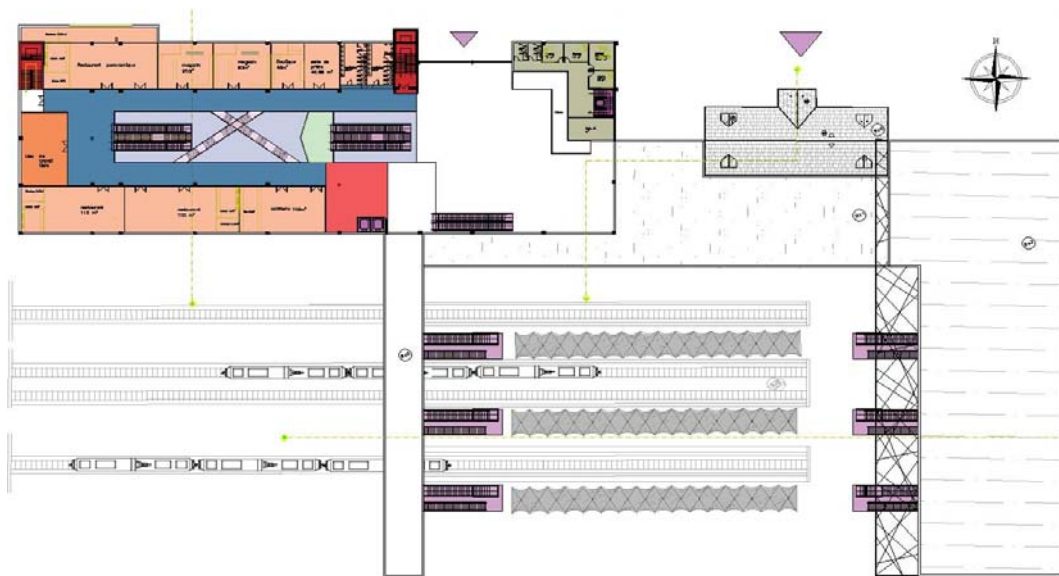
Plan du Troisième niveau ; Source : Auteurs
